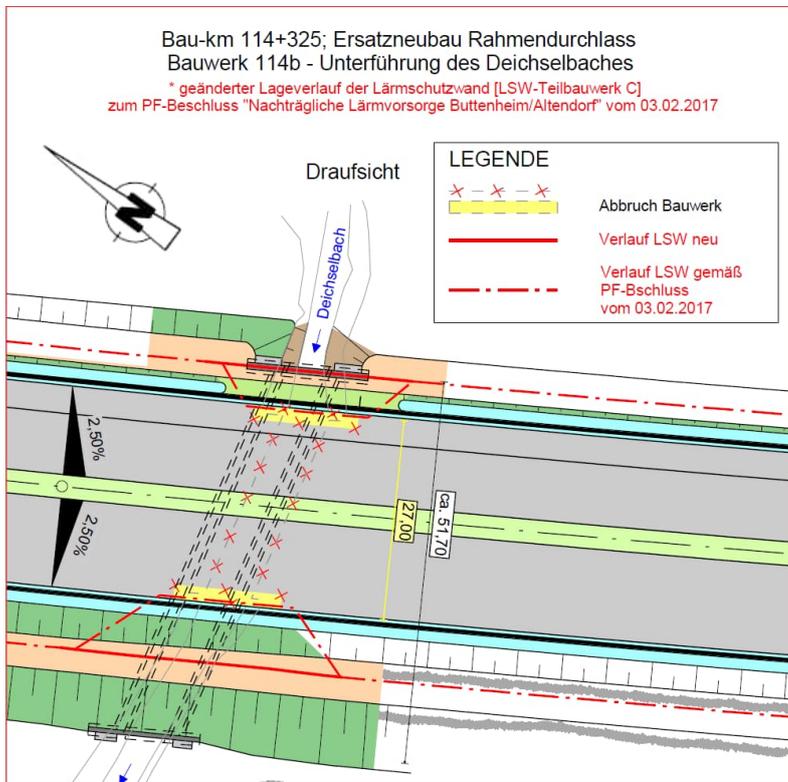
Auszug aus Lageplan Unterlage 5 Blatt 5, Lageplanausschnitt
